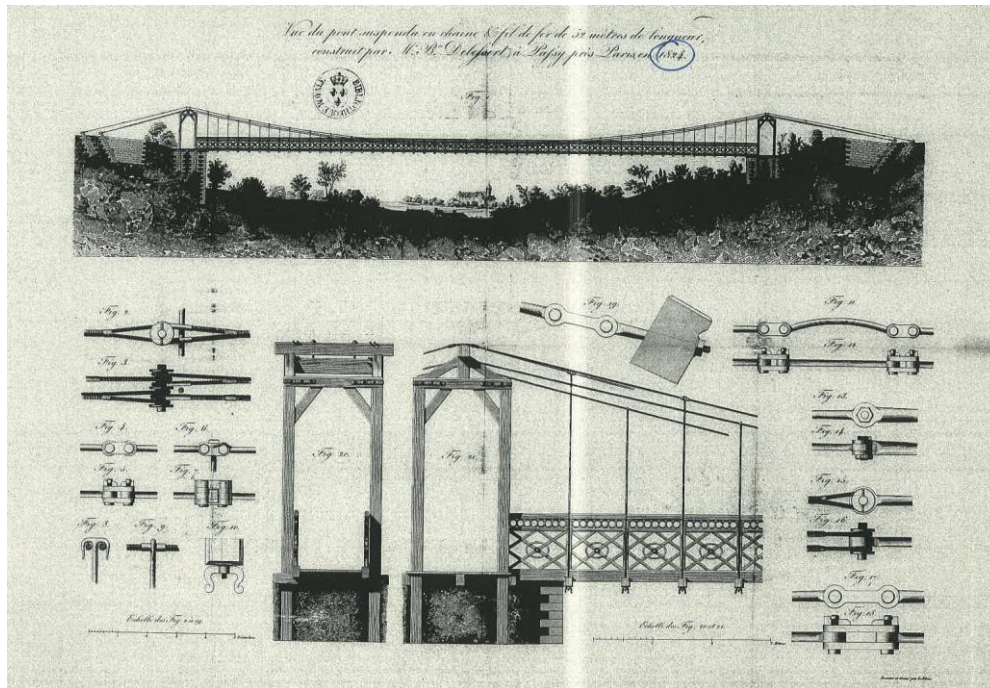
Vista del puente colgante con cadenas e hilos de hierro de 52 metros de longitud construido por Benjamin Delessert, en Passy, junto a París, en 1824.
